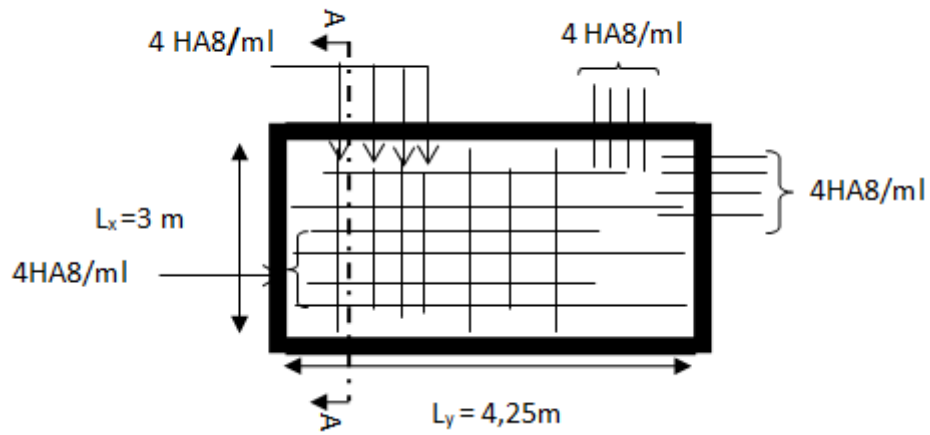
schéma de ferrailage de la dalle pleine de l'ascenseur .
